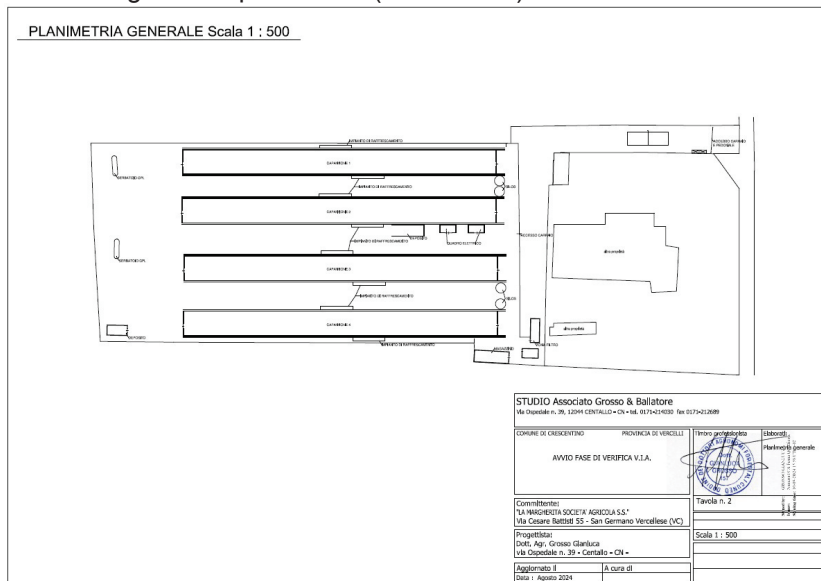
planimetria generale dello stabilimento (estratto elaborato 2 presentato)
